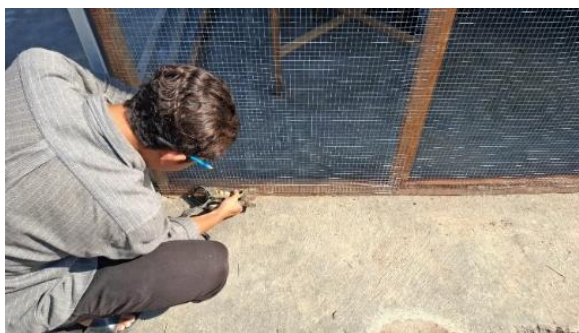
Hasil Pengawasan Pengerjaan Lantai Beton Rumah Sampah Anorganik
